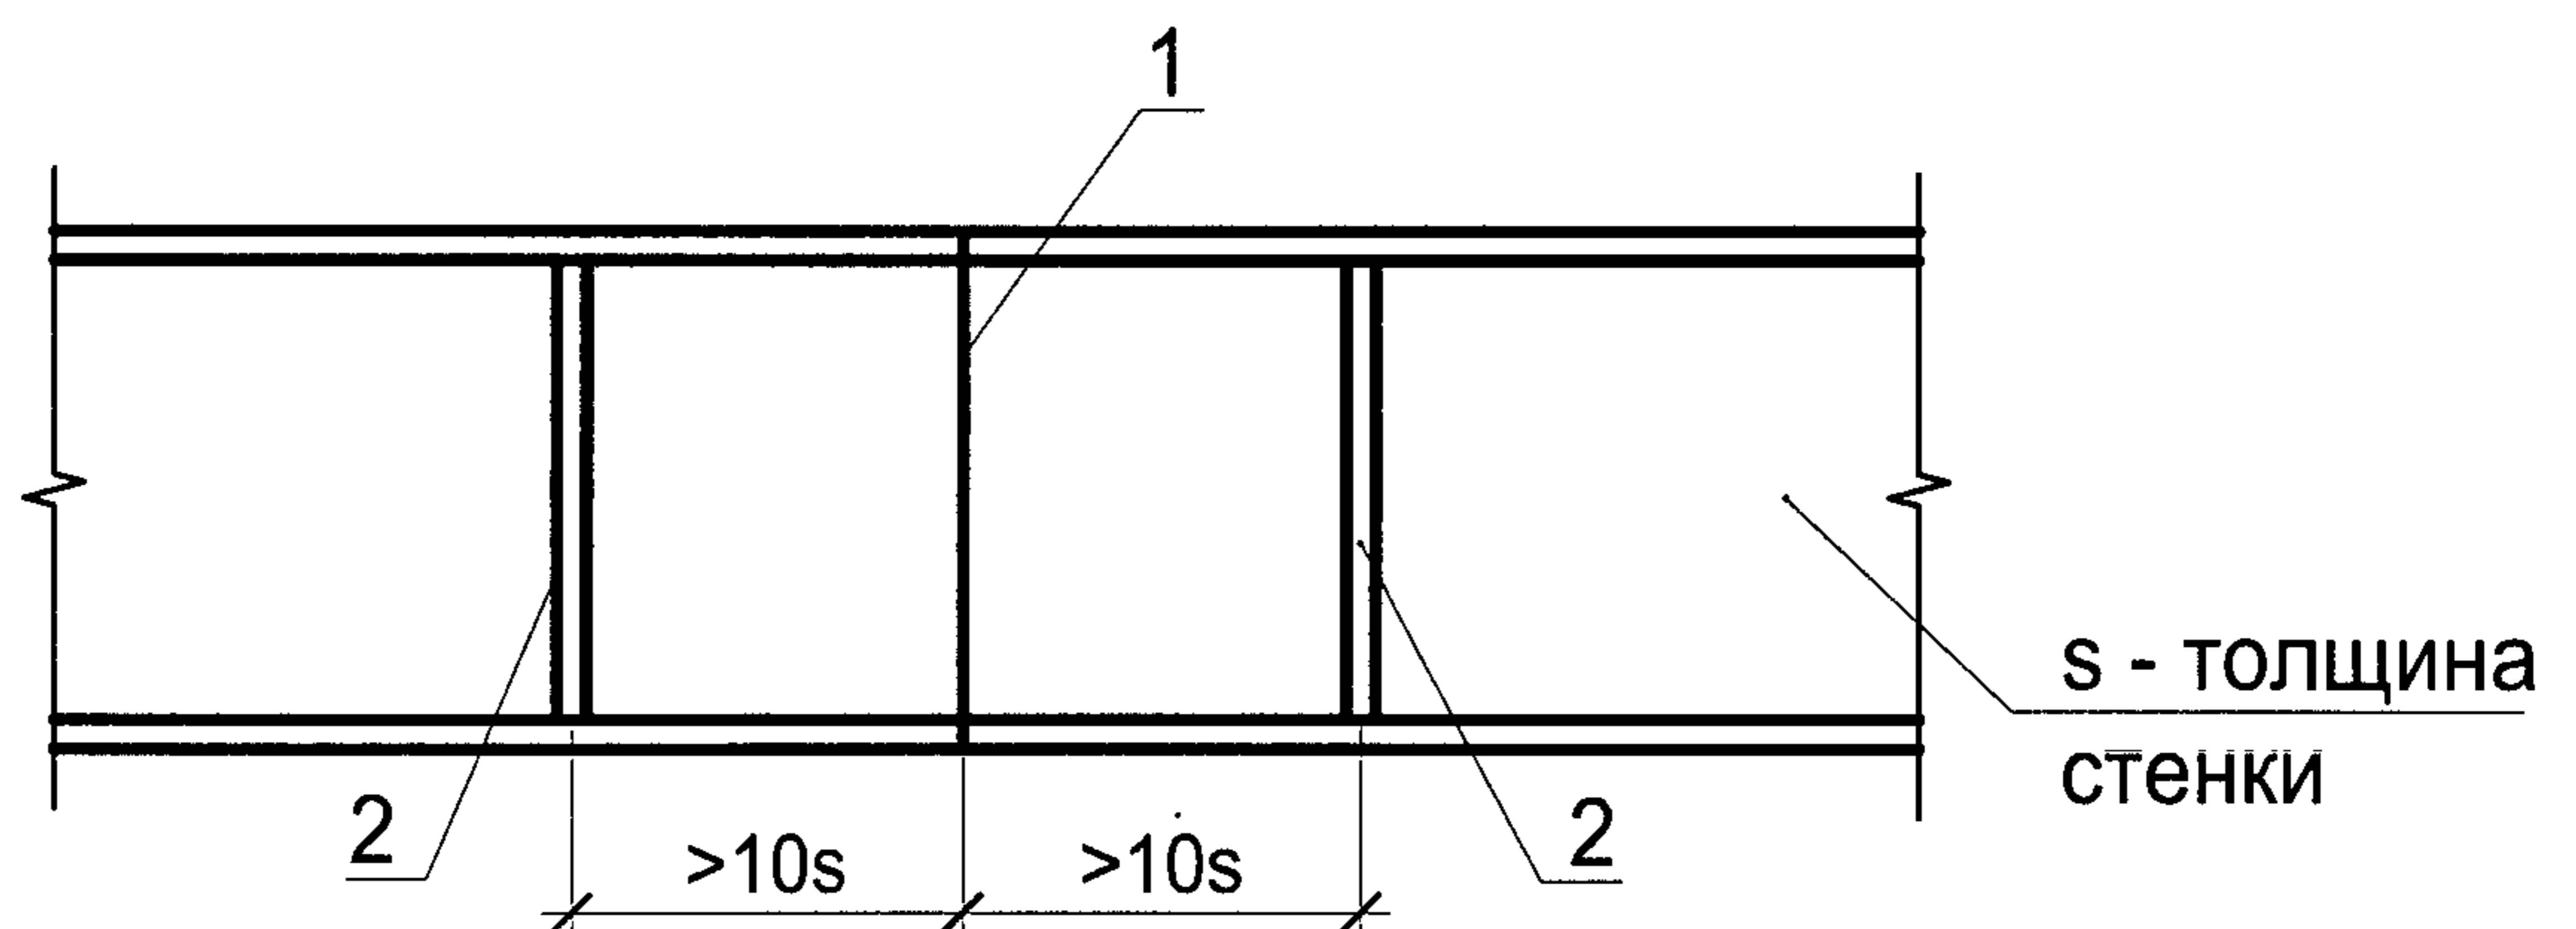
Расположение ребер жесткости, параллельных стыковым швам стенки балки.
